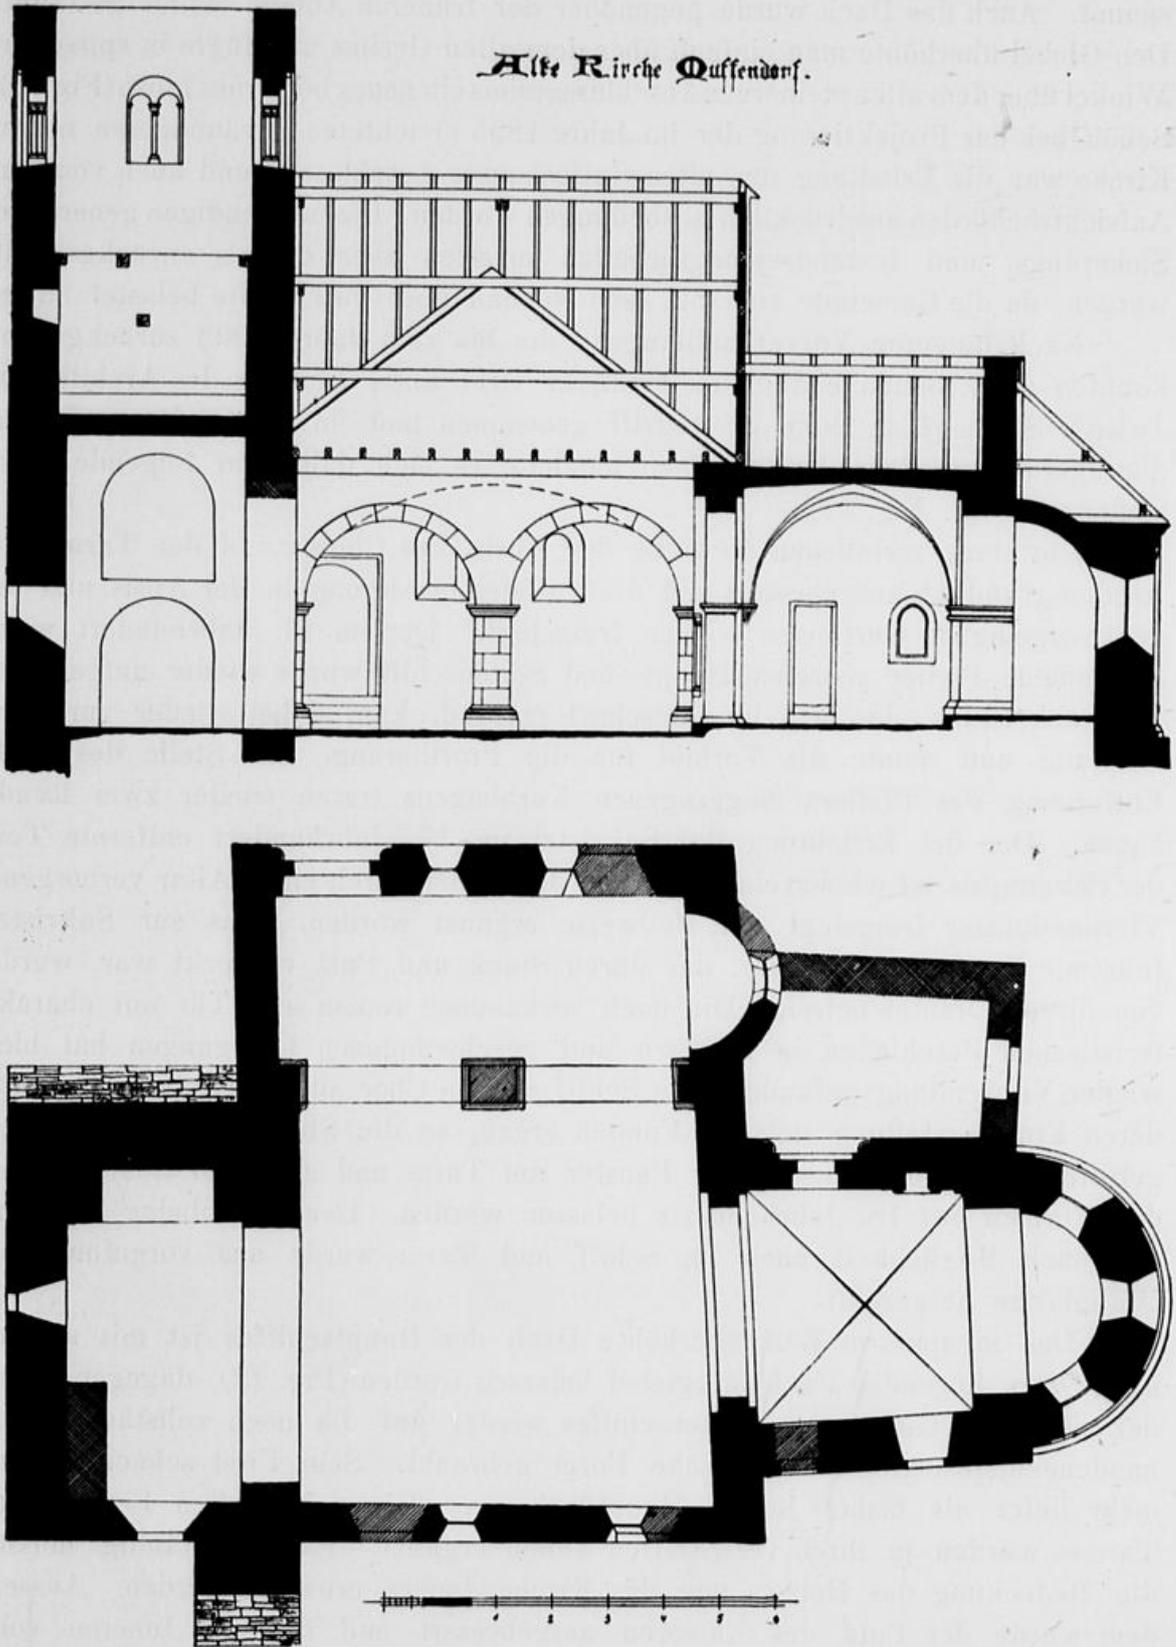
Muffendorf. Alte kath. Kirche. Längenschnitt und Grundriss.
